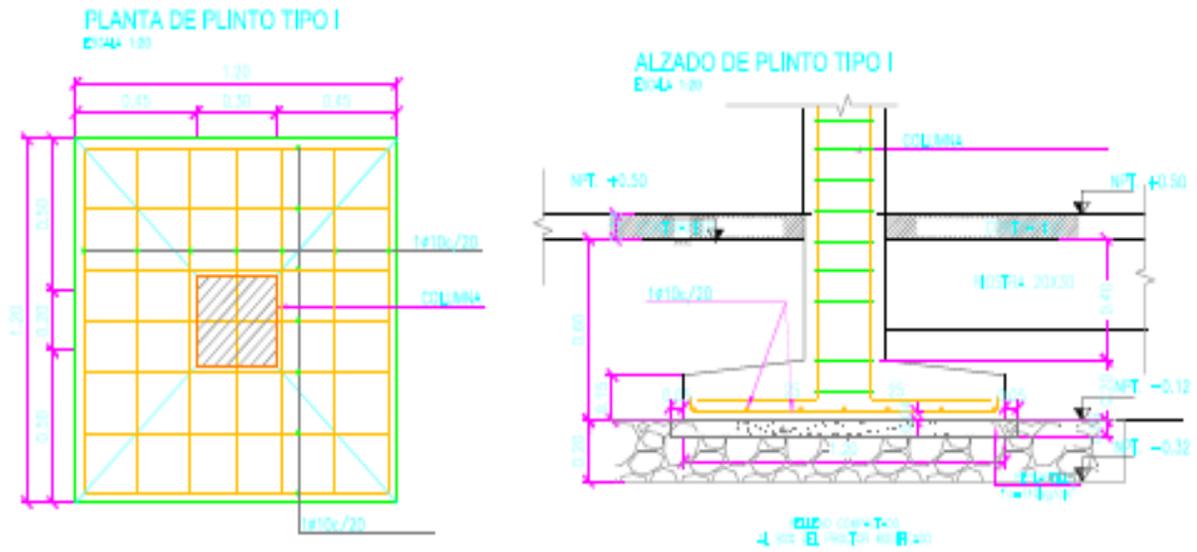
; Detalle de plinto 1 m para el diseño de hormigón armado
